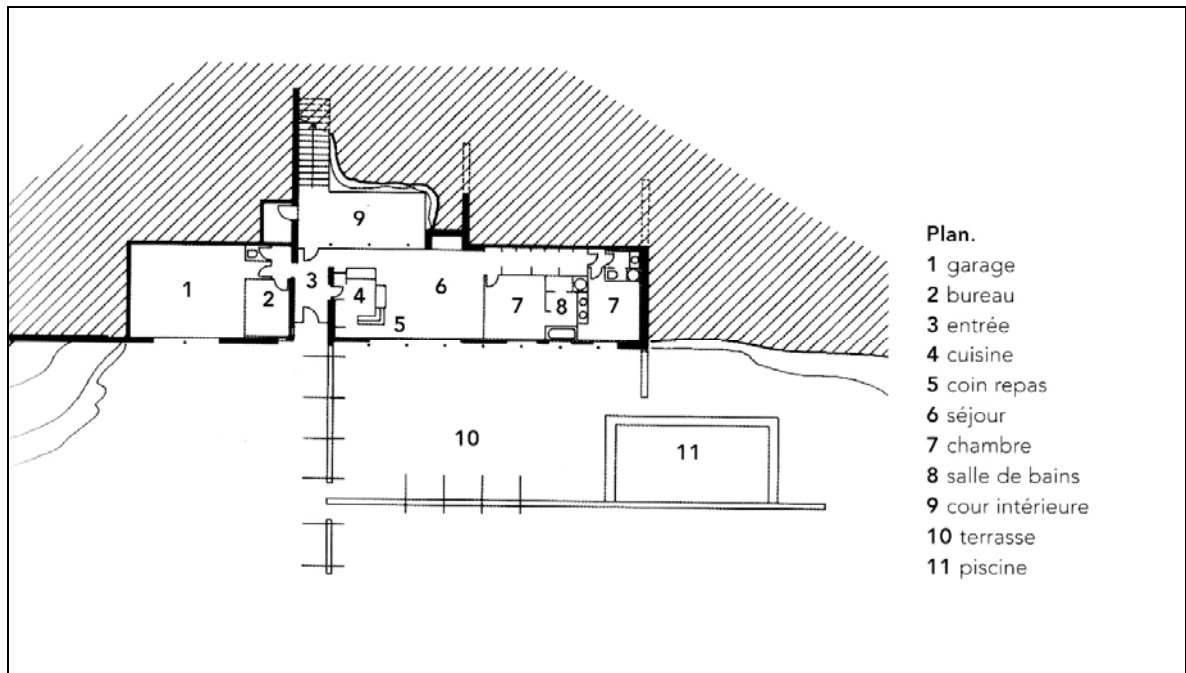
Plan de la maison Galopin (Gauzin-Müller, 2006)
